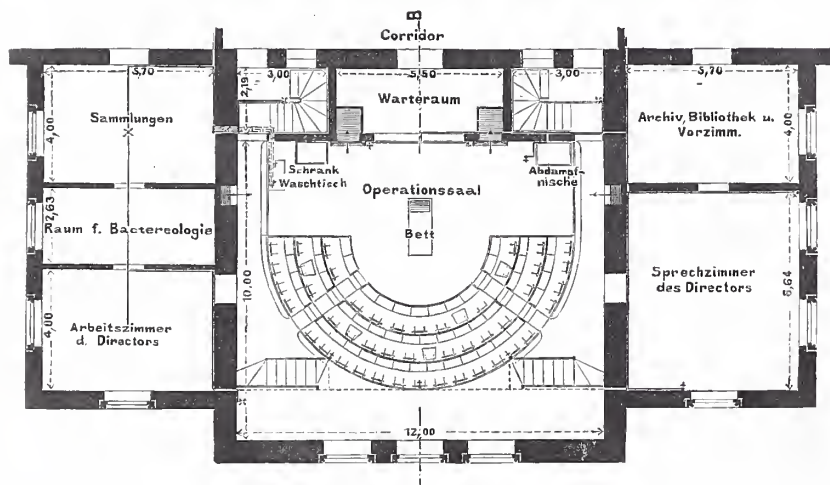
Unterer Grundriss (Schnitt c-d).
